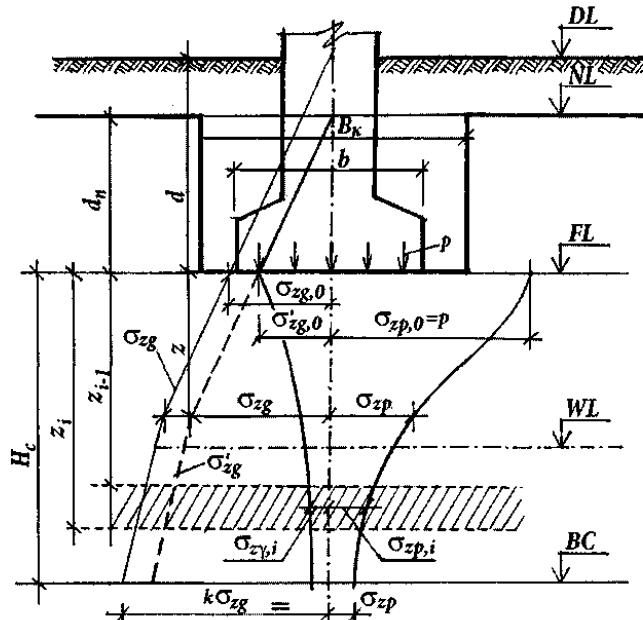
Схема розрахунку осадок фундаменту методом пошарового
